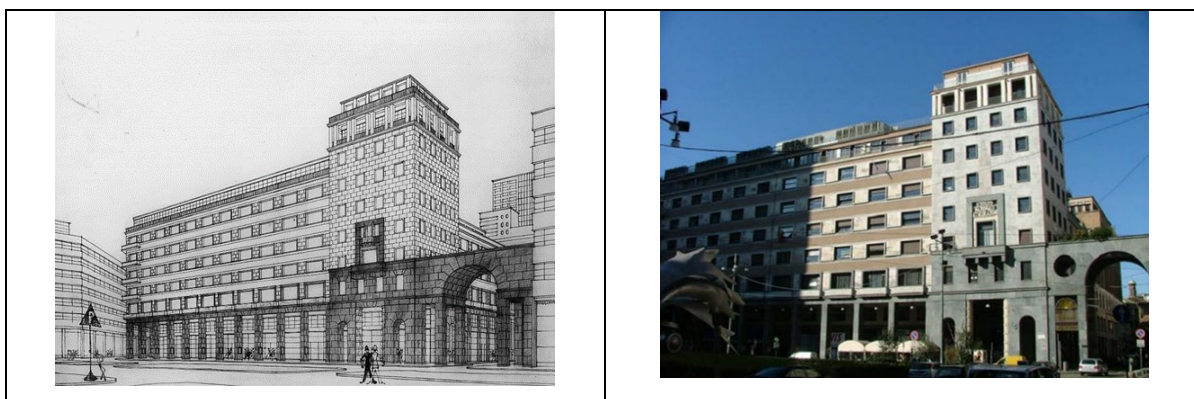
Prospettiva di progetto [Immagine gentilmente concessa da Fondazione Piero Portaluppi]
